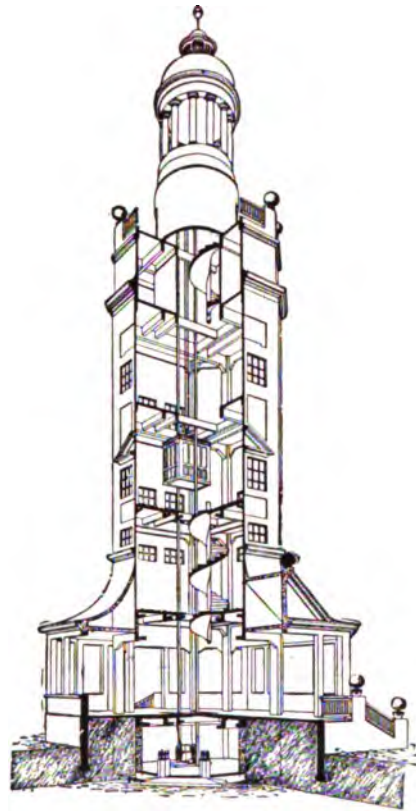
Wasser- und Aussichtsturm der bayer. Landesausstellung in Nürnberg 1906.
